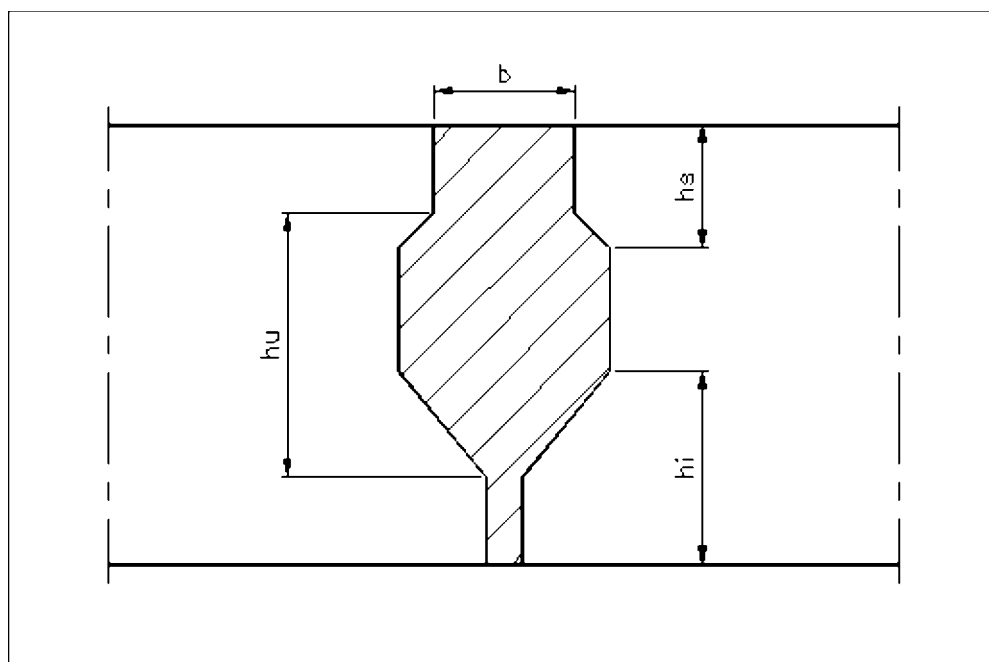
Principaux types de forme de joints et clefs - Schéma (b)
